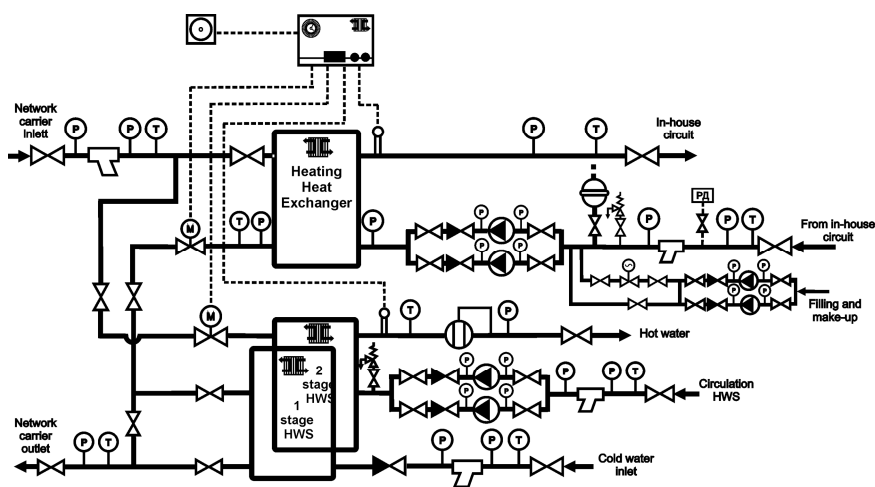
Принципиальная схема индивидуального теплового пункта системы отопления и ГВС (двухступенчатая смешанная схема)
